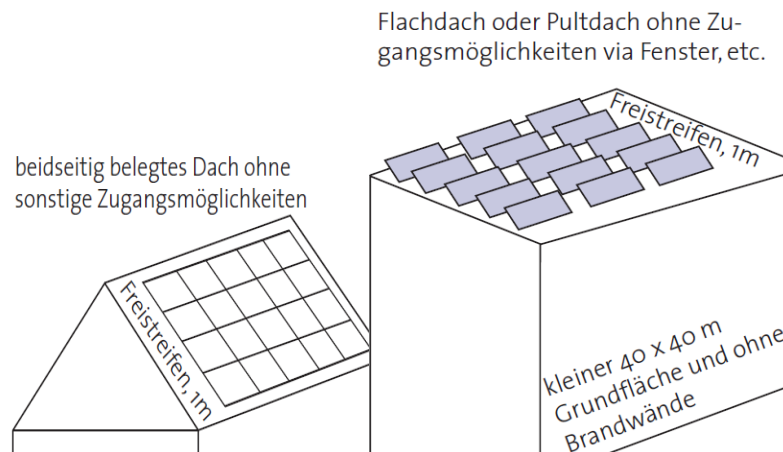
Darstellung Zugangsmöglichkeiten zum Dach; Originalbild Expertenkommission „Brandschutzgerechte Planung, Errichtung und Instandhaltung von PV-Anlagen
